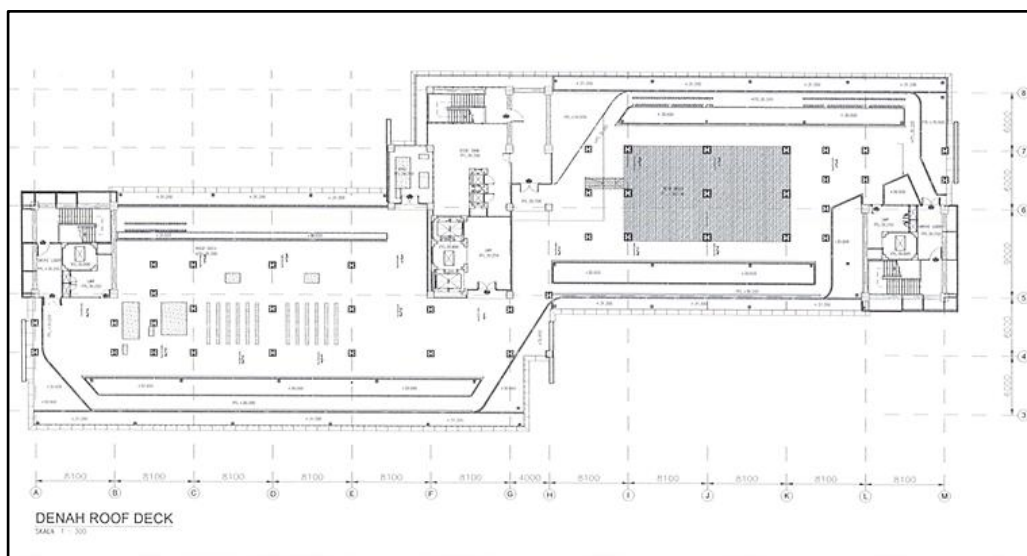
Denah Lantai 6 Gedung Ibu dan Anak RSUP Dr. Sardjito
